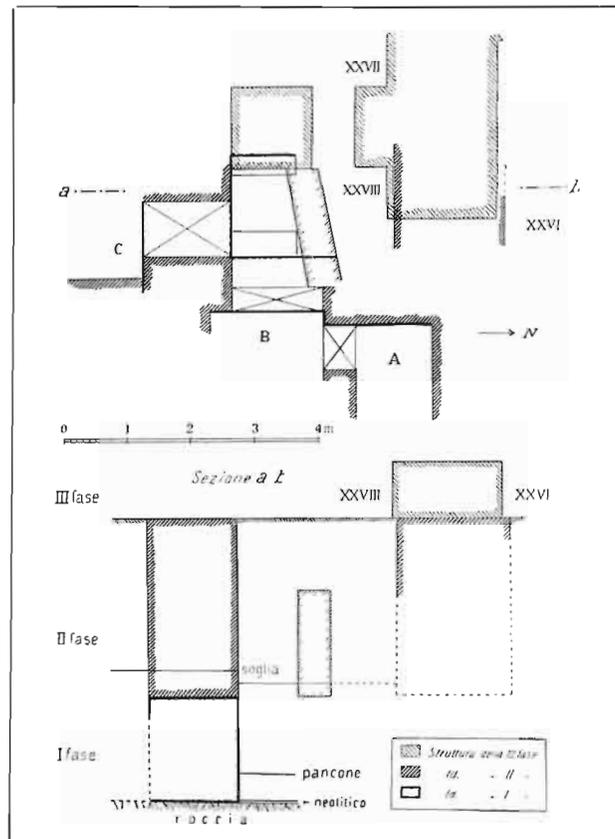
FESTÒS, VANO XXVIII - PIANTA E SEZIONE DELLO SCAVO
